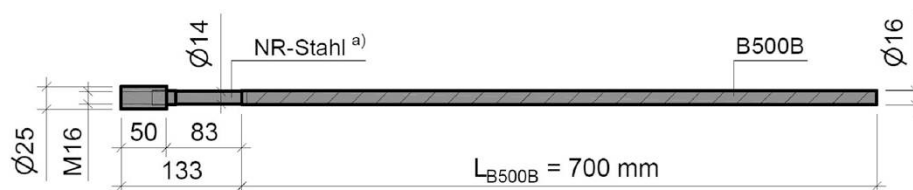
Muffenstab Ø16 für Isokorb® IQ K (Einbindelänge im Beton ≥ 100 mm und gemäß Abb. 3 und Abb. 4 bei ungefüllter Montageaussparung)
